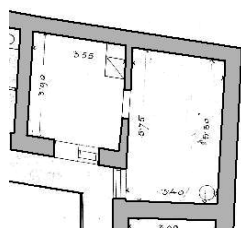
Однокімнатне помешкання анфіладного планування у будинку за адресою Краківська, 18. 1898 р. (Сільник, 2008)
